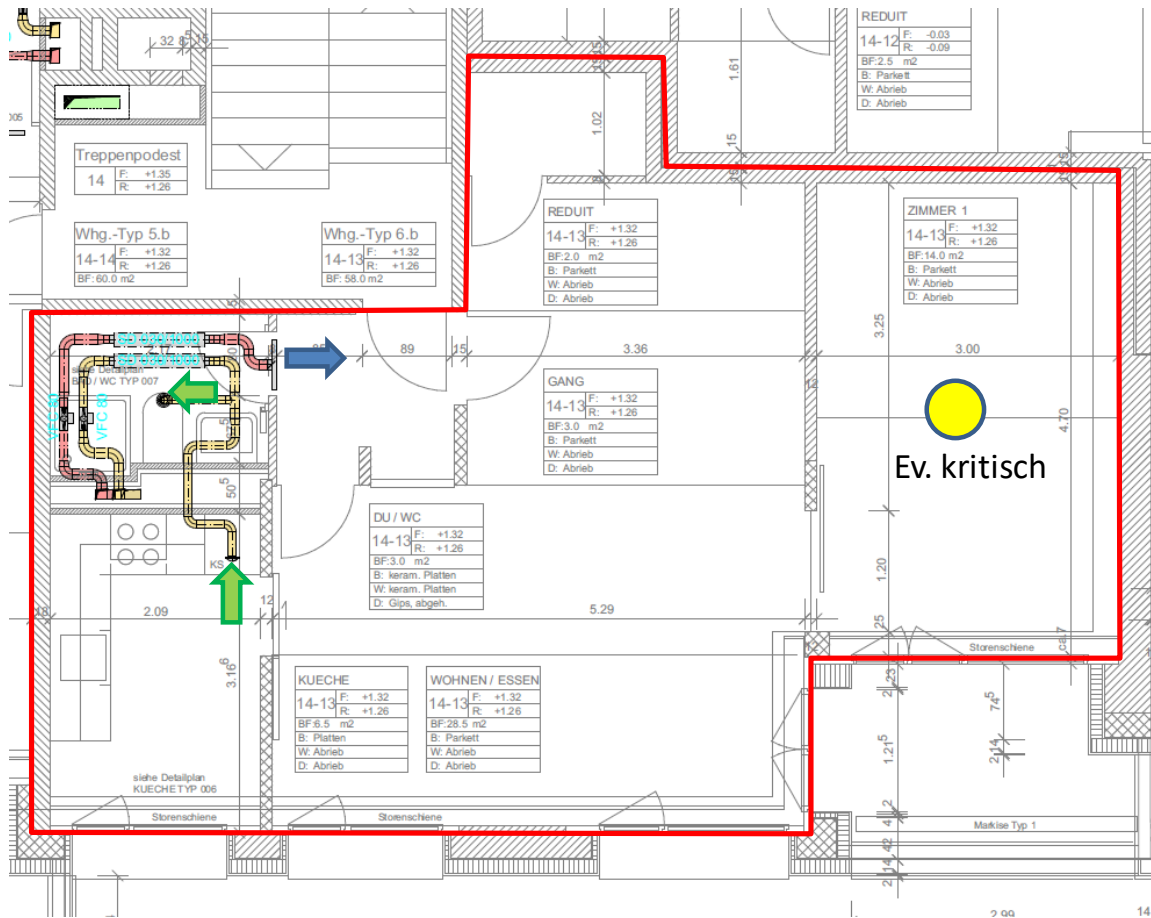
Planauszug ungünstiger Grundriss 2.5-Zi WNG (Bildquelle: Amt für Hochbauten 2017)
